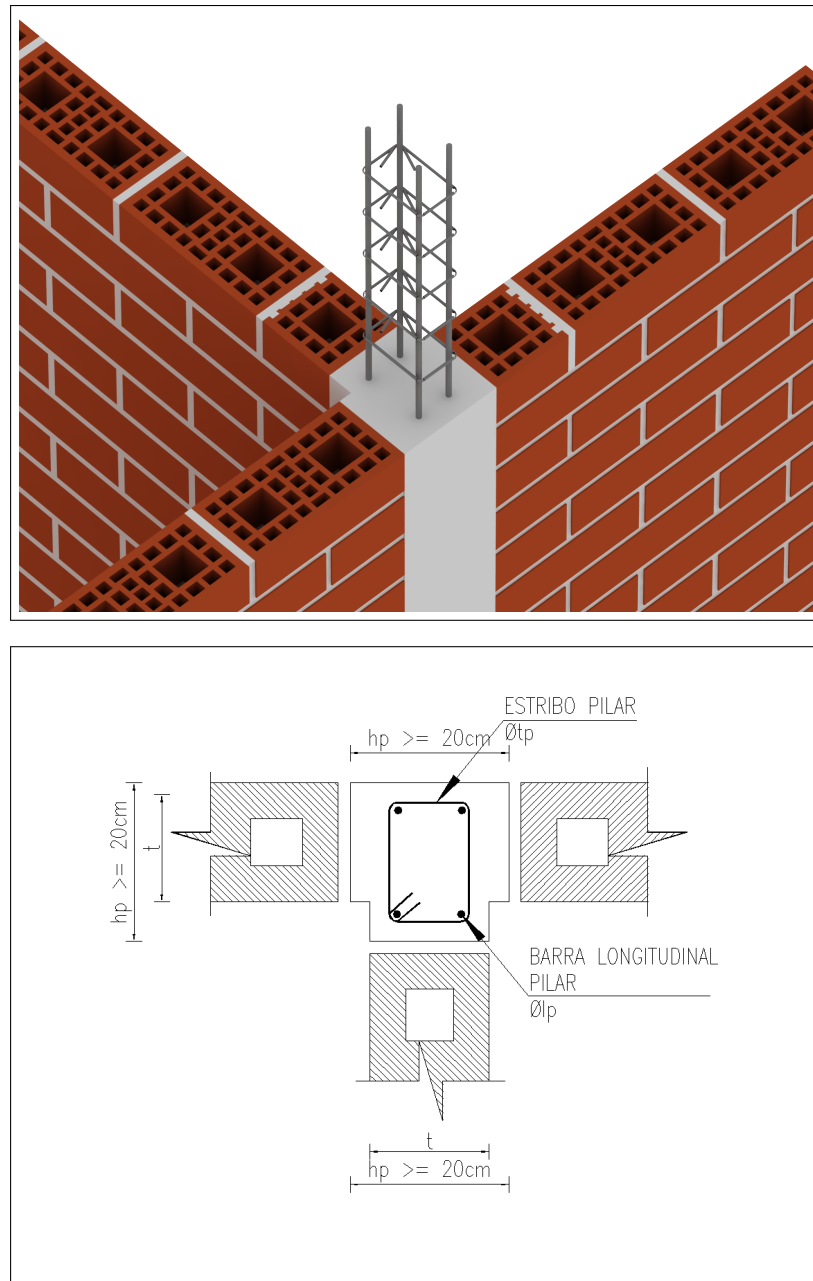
Dimensión mínima de un pilar para encuentro de muros en T y armado en la dirección donde actúa como pilar de borde libre
